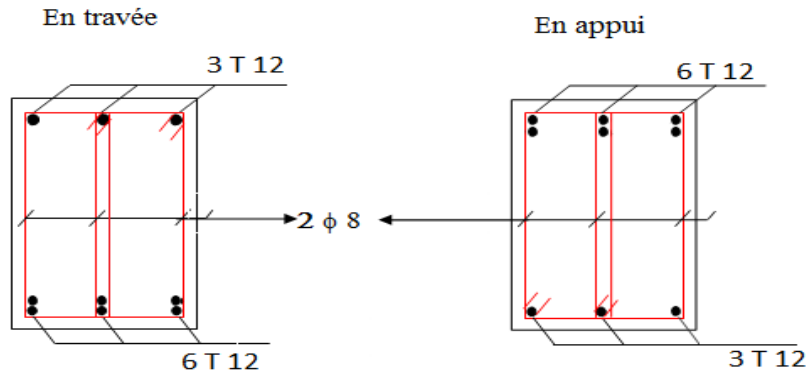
Ferrailage des poutres principales (30 × 40)
